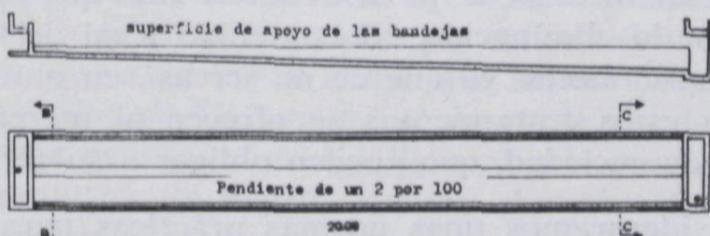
Plano detallado de una balsa de depuración — Arriba : Corte longitudinal — En el centro : Planta
